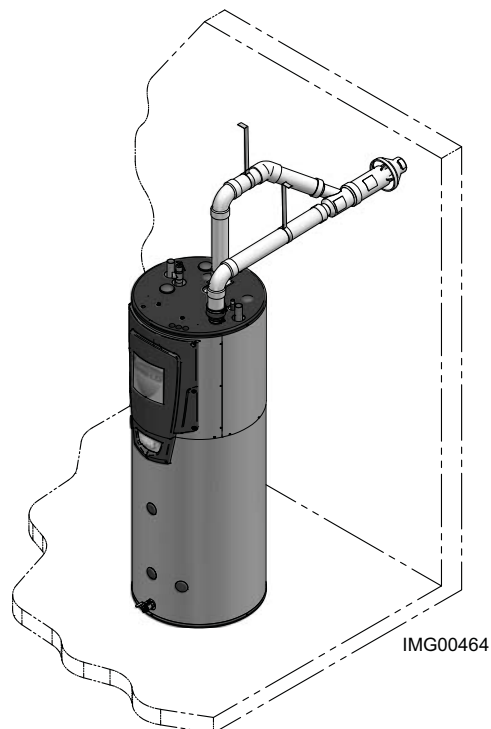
Terminaison murale concentrique en PVC/CPVC - Voir page 27 pour d'autres détails
